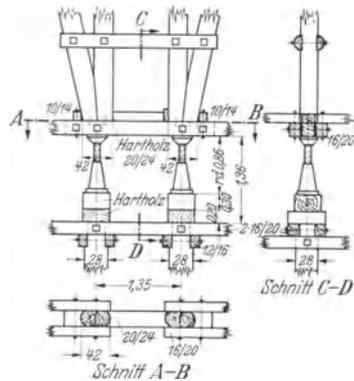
Anschluß der Pfosten und Streben an eine zweiteilige Schwelle.
